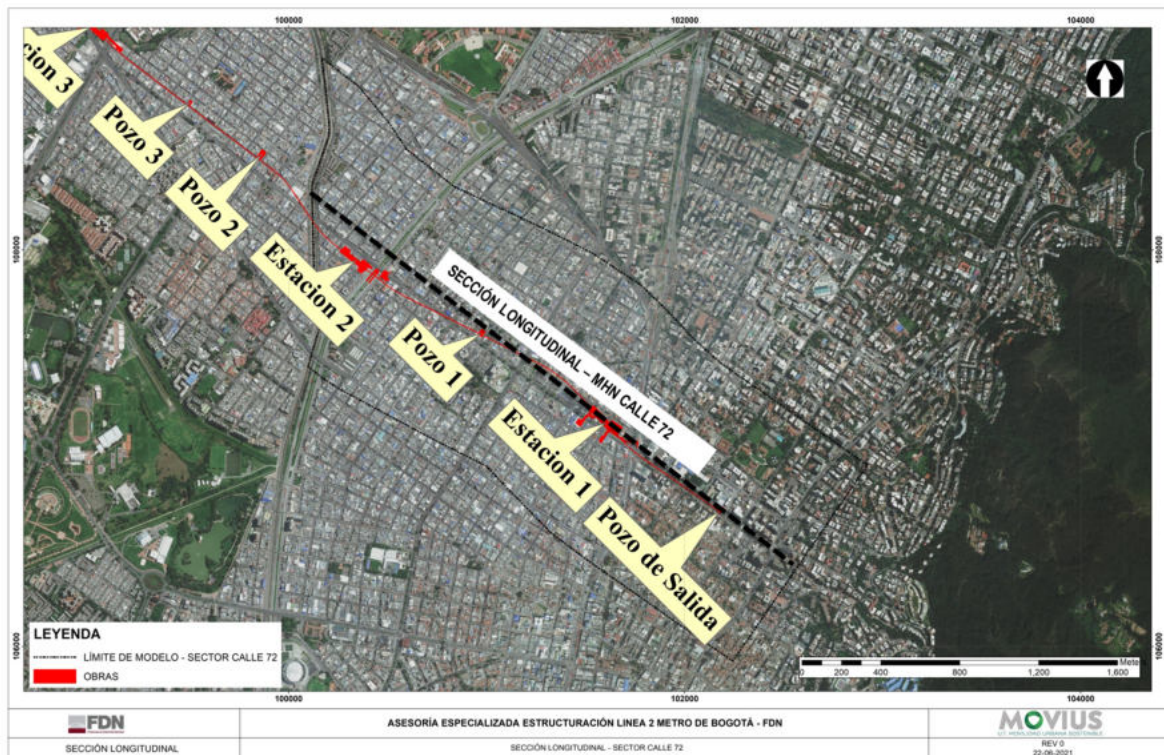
Ubicación en planta sección longitudinal - Sector Calle 72 , Columna 70 del modelo.
